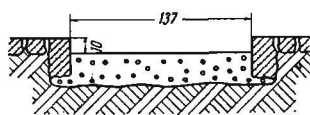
Schnitt durch die Kotgangverlängerung außerhalb des Stalles
